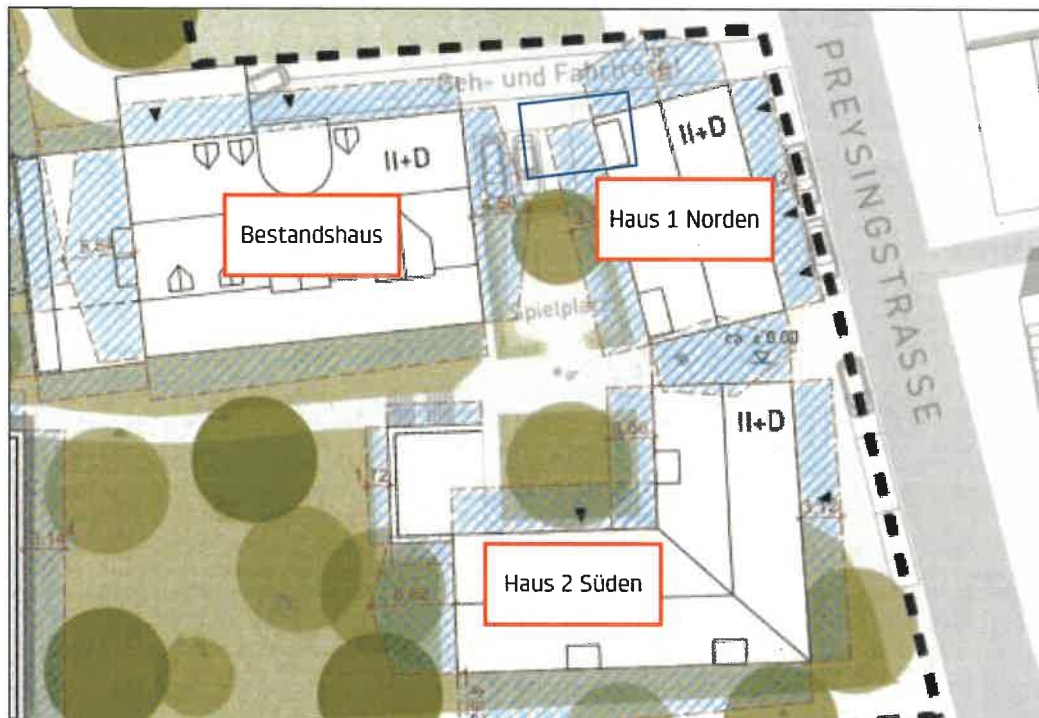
Lageplan mit Darstellung der Wohn- und Geschäftsgebäude
